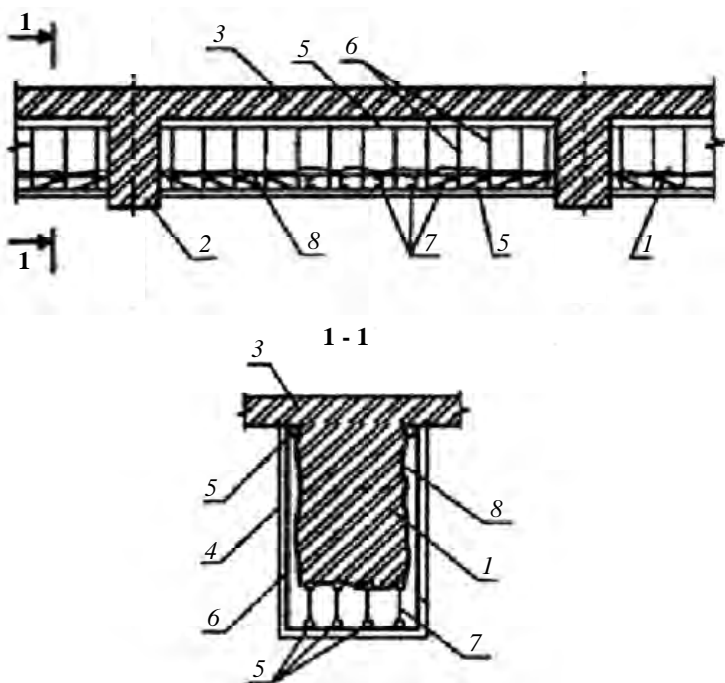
Устройство железобетонной рубашки усиления балки без вывода хомутов через плиту перекрытия:
